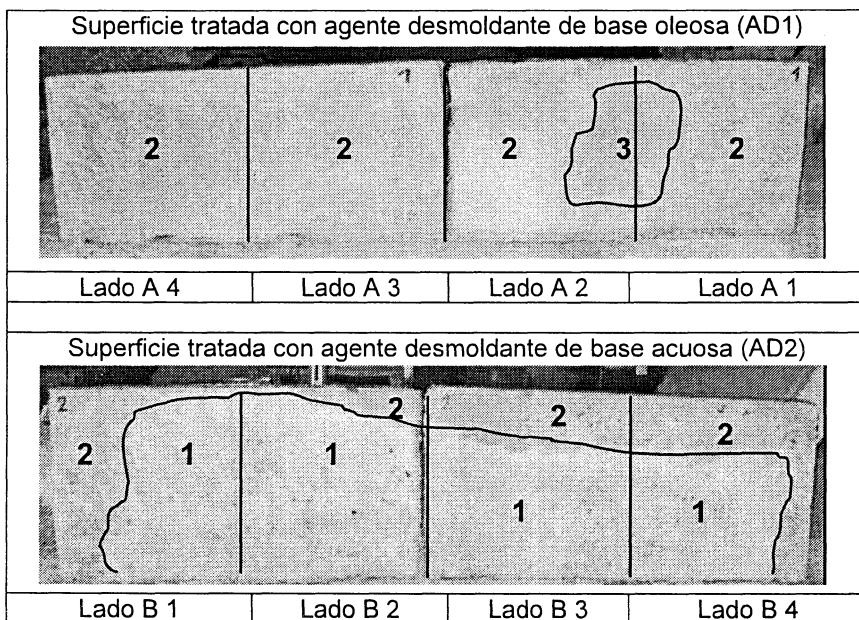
a. Relevamiento del color en el panel llenado con el hormigón H1.
